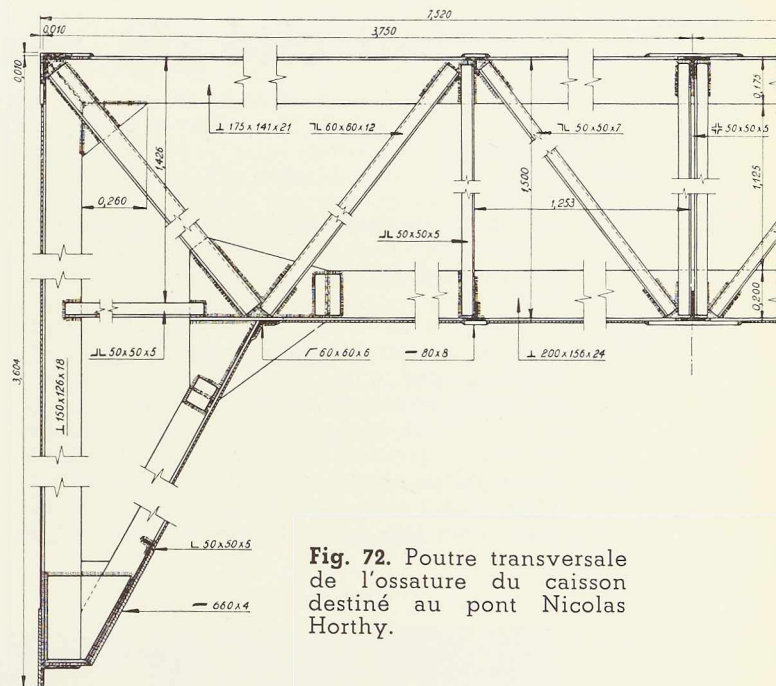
Poutre transversale de l'ossature du caisson destiné au pont Nicolas Horthy.
